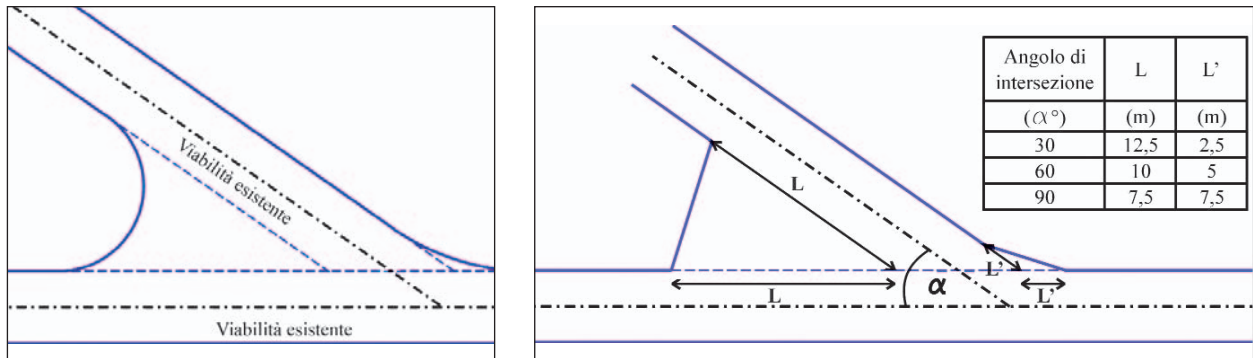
Schema di intersezione con allargamento ad arco di cerchio.
